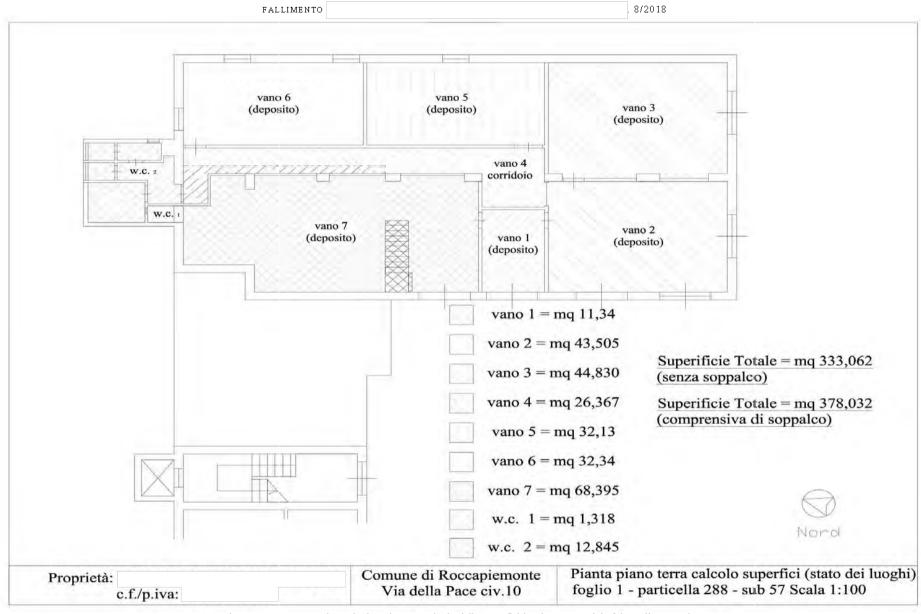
rappresentazione planimetrica con calcolo delle superfici locale commerciale fgl. 1 p.lla 488 sub 57
